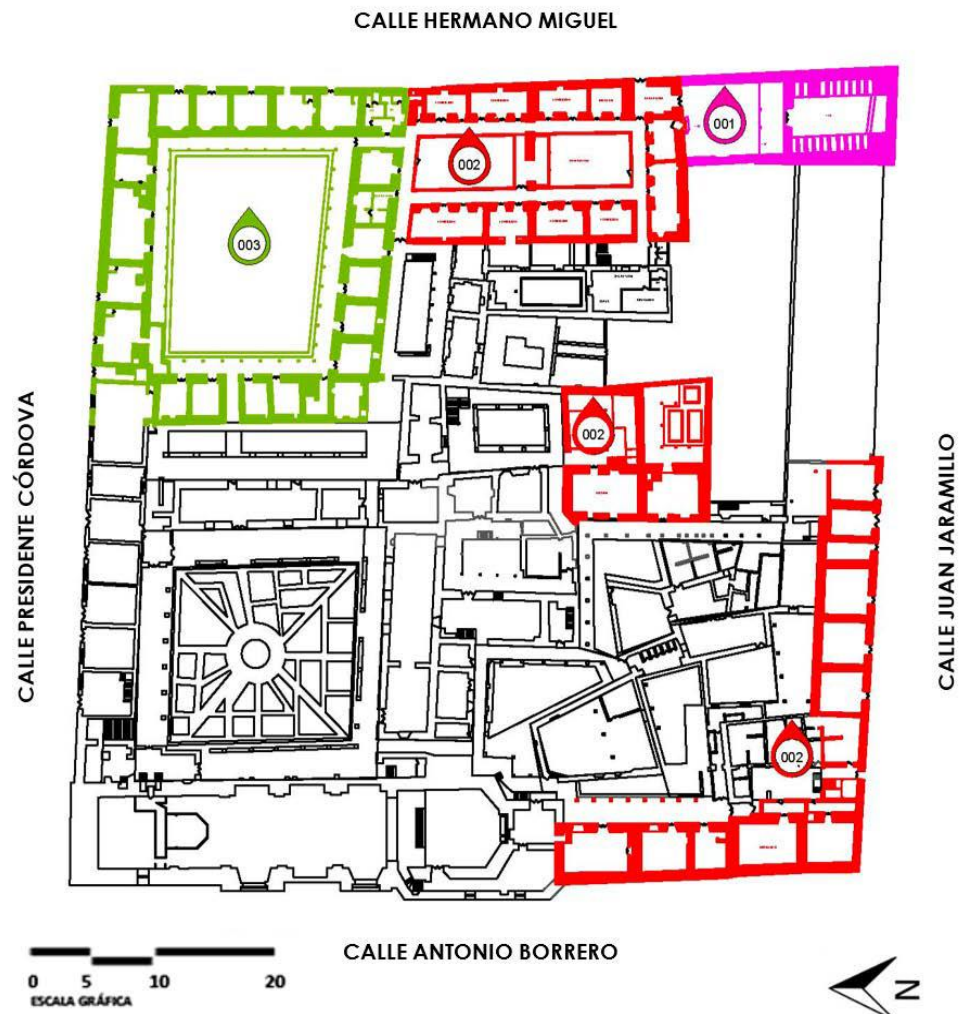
Plano Cronológico 1800-1900 Planta Baja
